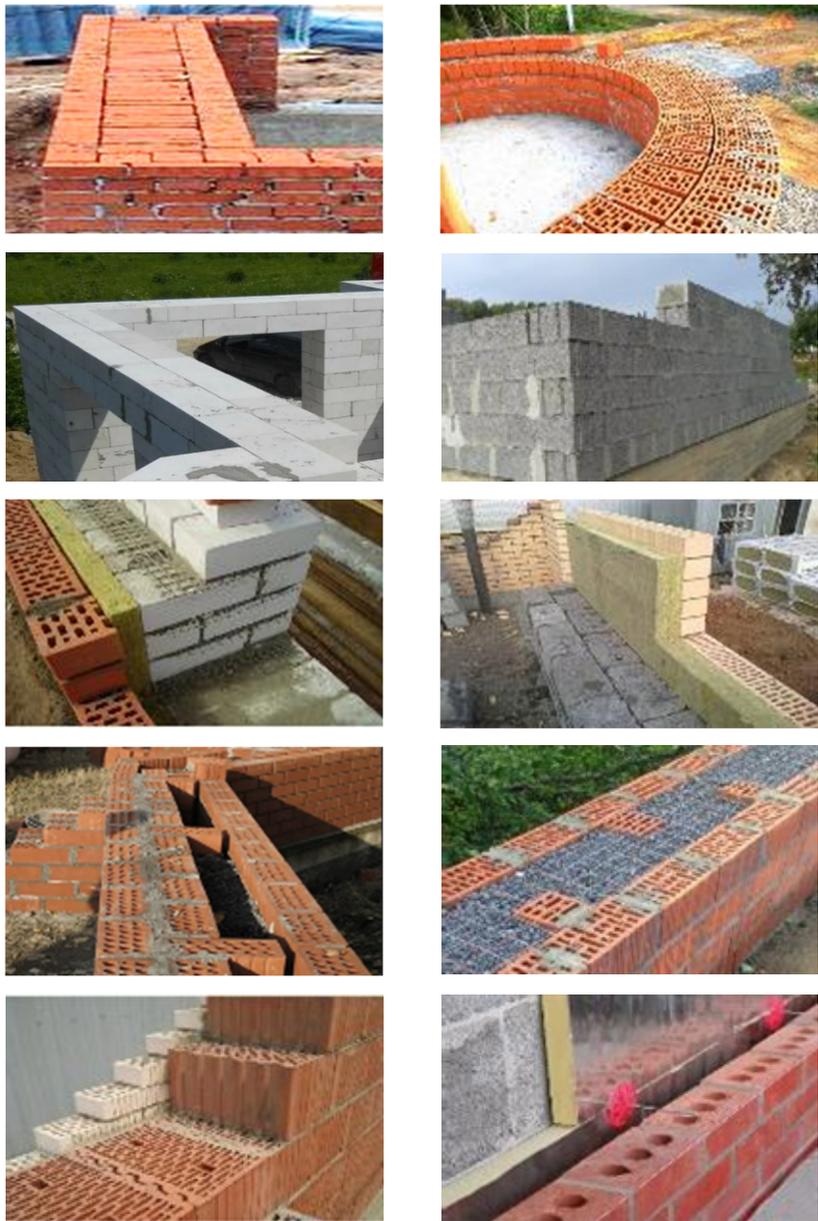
Примеры кладки стен гражданских зданий
